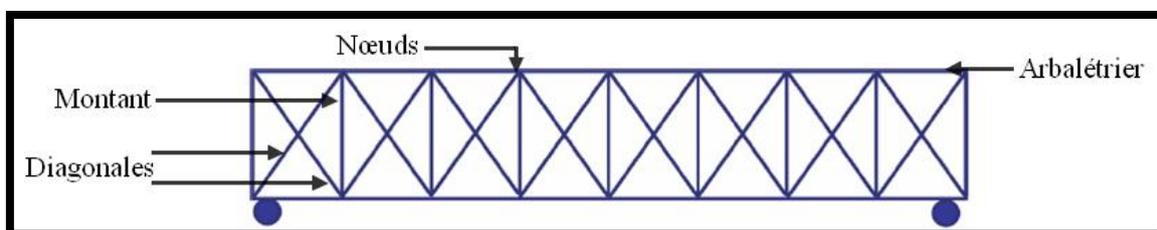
Les éléments d'une poutre en treillis<sup>196</sup>
